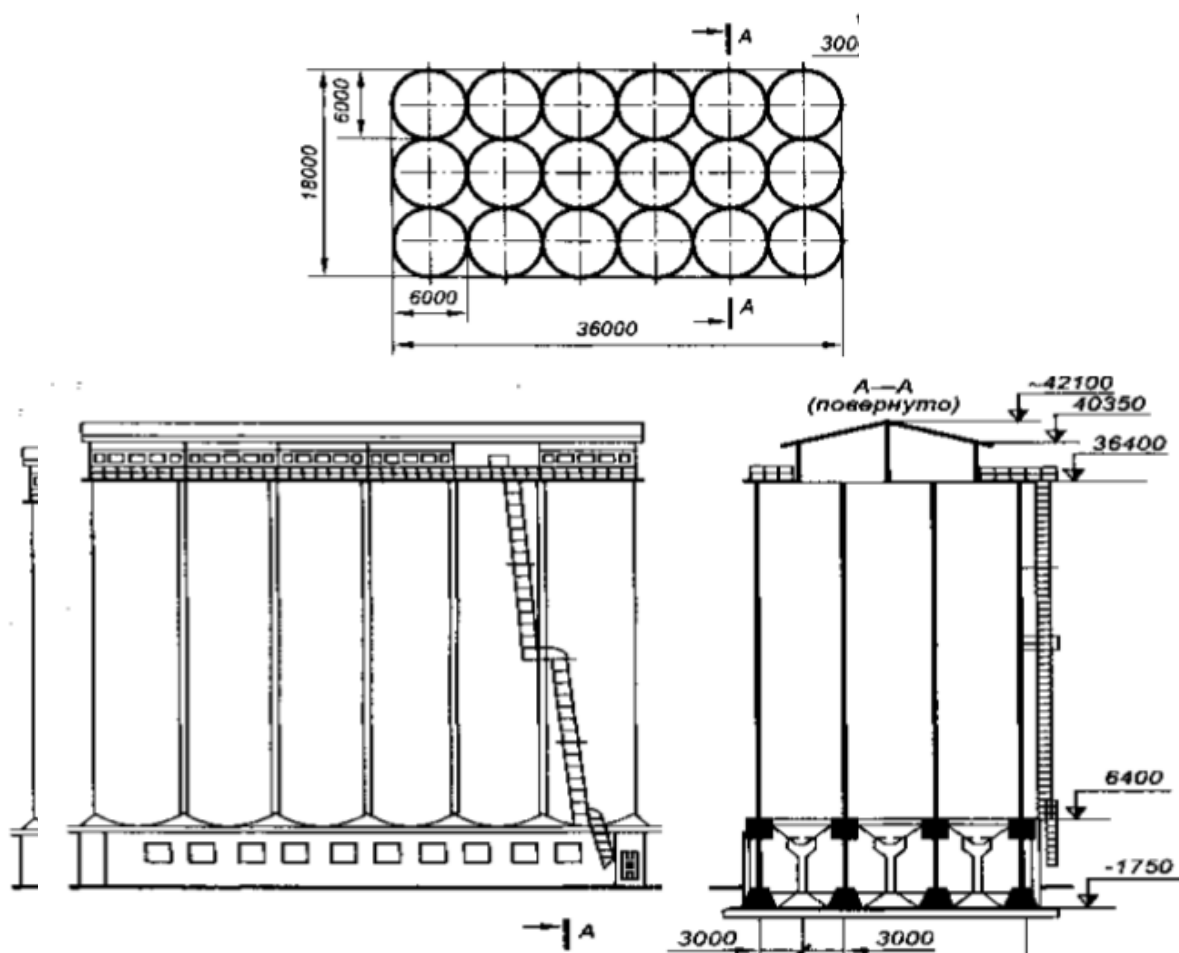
Конструктивна схема силосної споруди: план; фасад; поперечний розріз башти силосу
